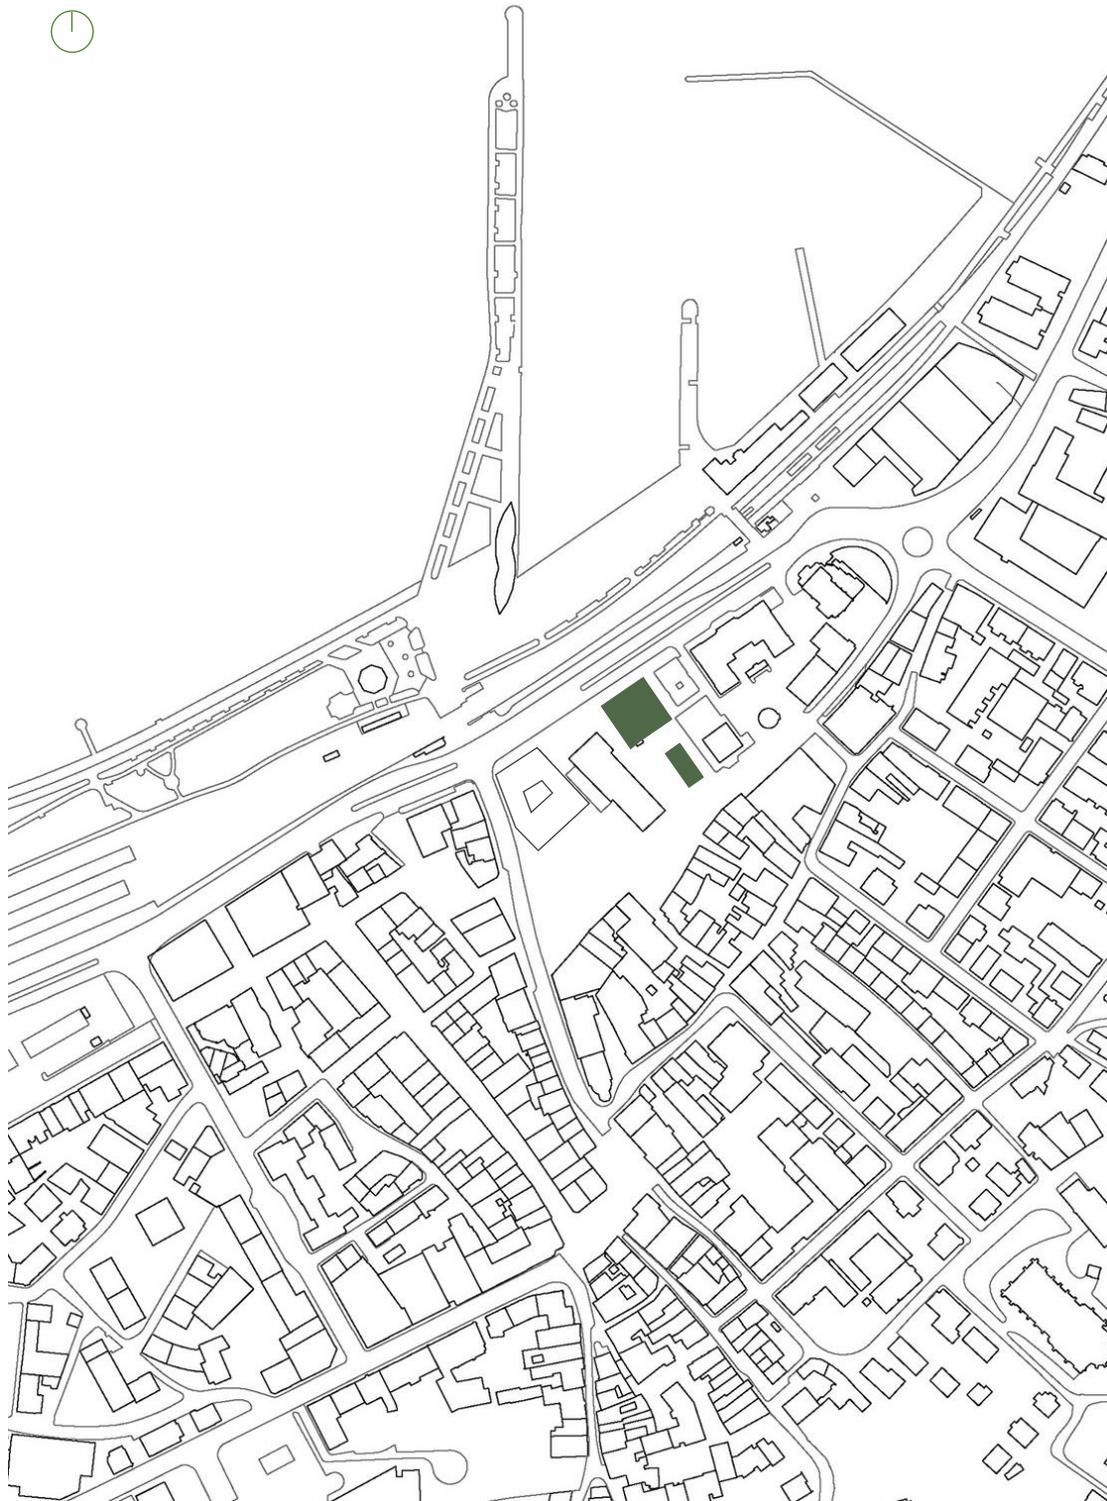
Planta de localização do Kunsthhaus Bregenz, em Bregenz, junto ao lago de Constança
